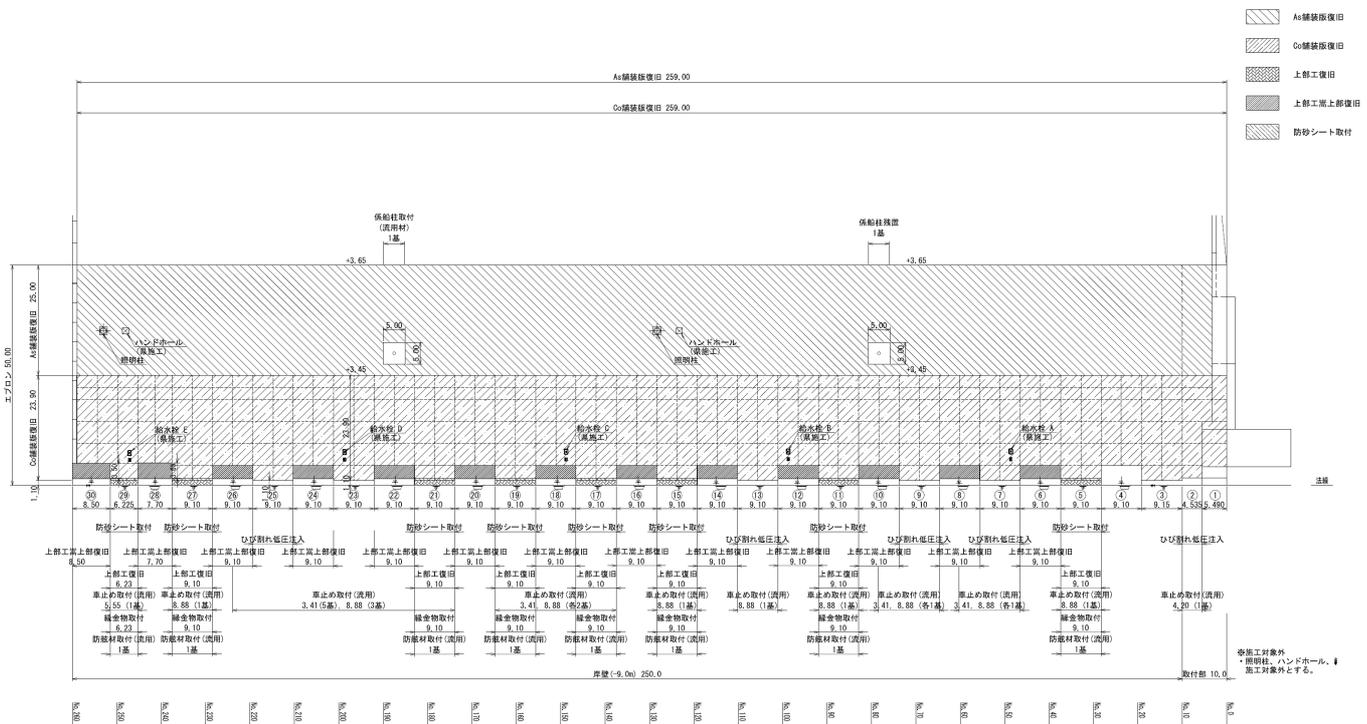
No.3 常陸那珂港区_中央ふ頭地区岸壁 (-9m)の平面図 (復旧後)
